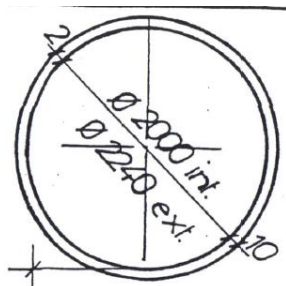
Extrait du plan d'exécution : calepinage buse béton
